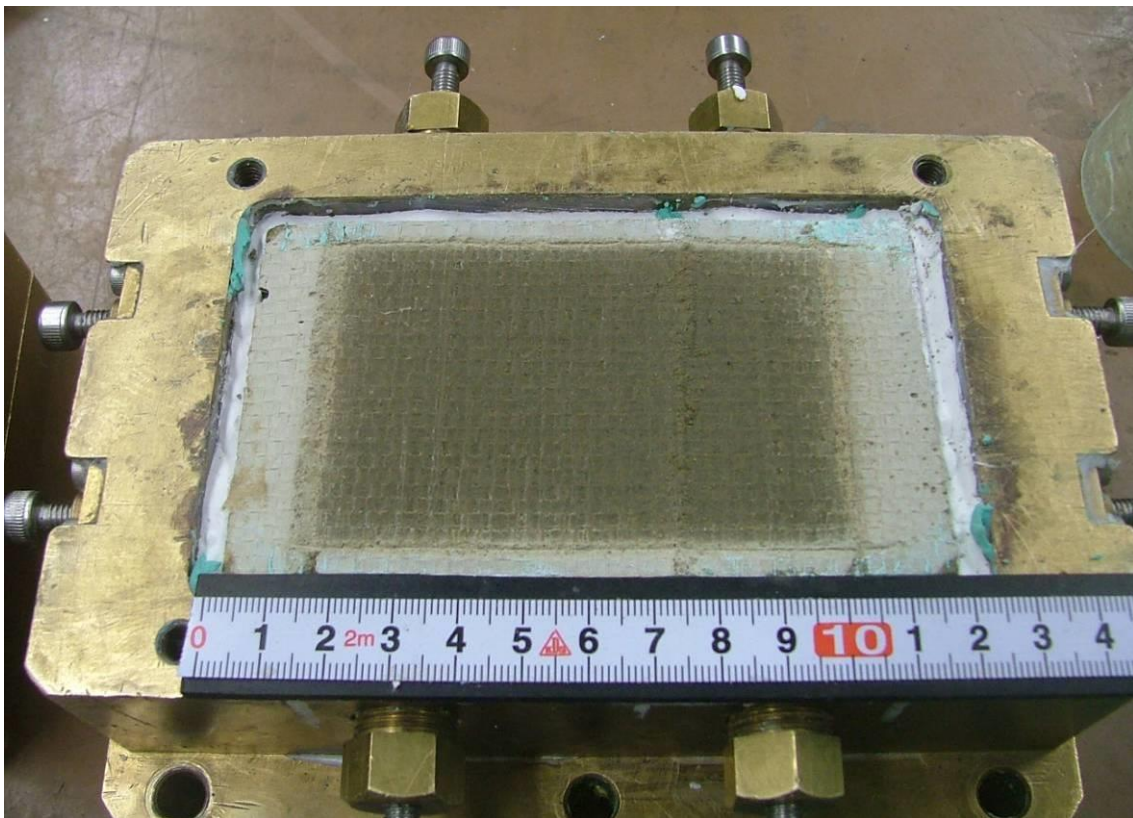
繰返し荷重試験 試験後の供試体状況 ケース 1-5 (西山モルタル表面)
